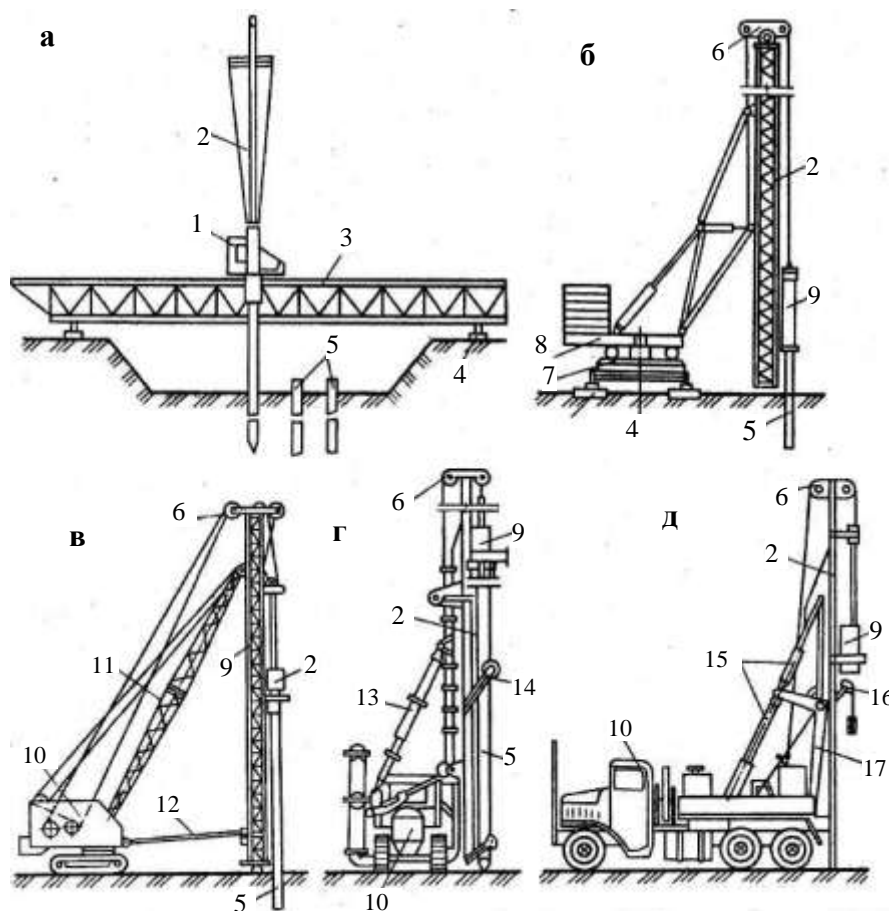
Палейні копирі установк: а – бруківка; б – рейкова універсальна; в – на базі екскаватора; г – на тракторі; д – на автомобілі; 1 – кабіна; 2 – копова щогла; 3 – міст; 4 – рейковий шлях; 5 – палі; 6 – напальник з блоками; 7 – привід-візок; 8 – поворотна платформа; 9 – молот; 10 – базова машина; 11 – стріла; 12 – розпірка; 13 – гідроциліндр; 14 – висувний механізм; 15 – гідроциліндр підйому і нахилу стріли; 16 – механізм піднімання палі; 17 – рухома рама
